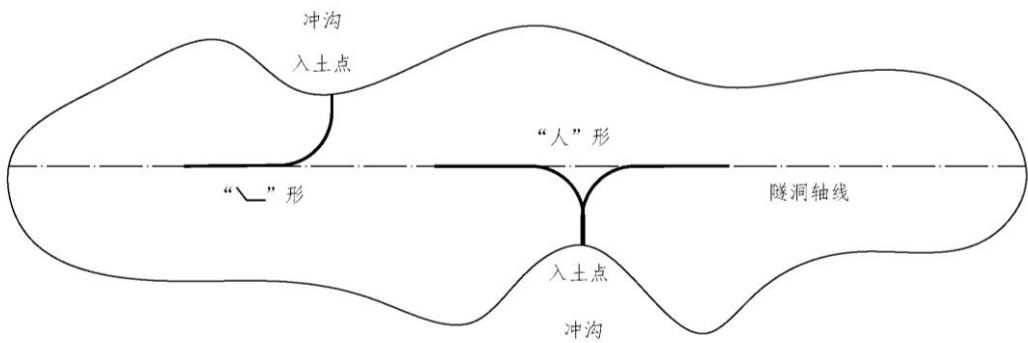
深埋长隧洞水平定向钻孔轨迹平面示意图
